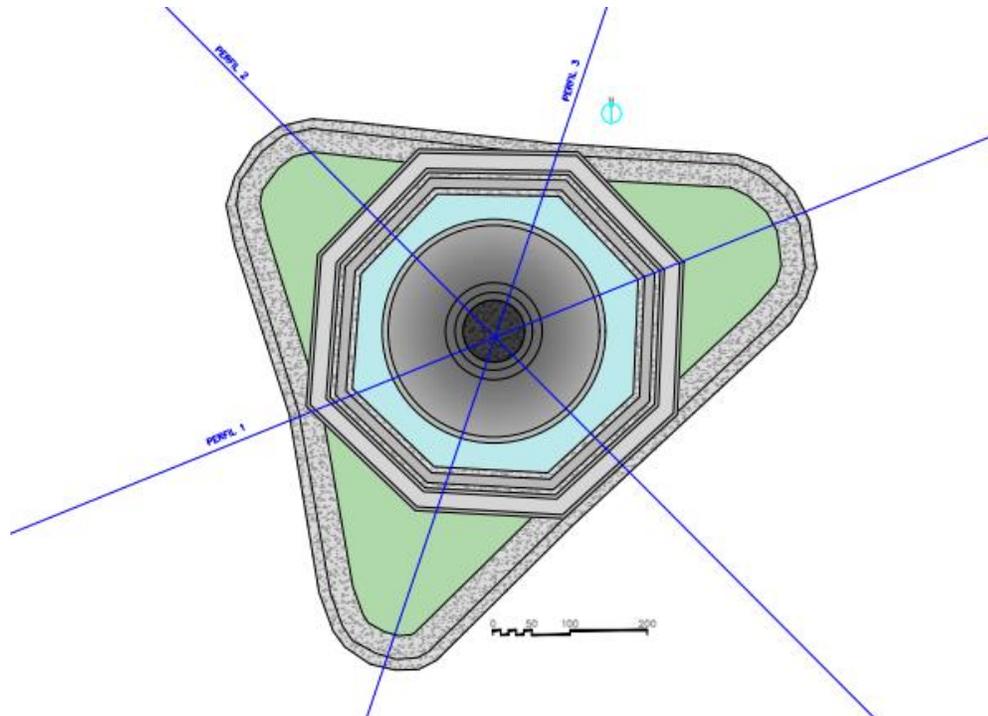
detalle constructivo en planta de la fuente, jardinera y andén perimetral
